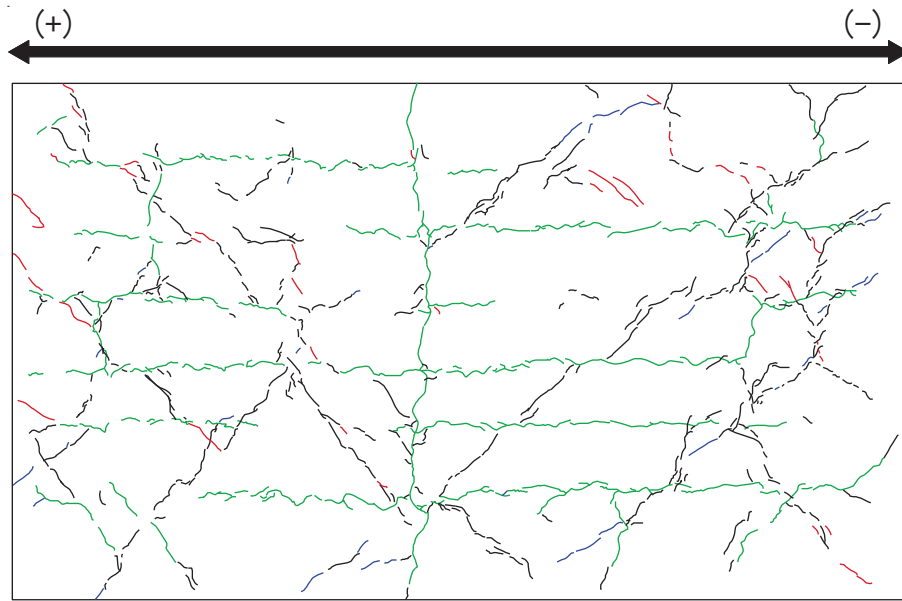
(7) 乾燥試験体 [1] 1/1250rad. におけるひび割れ図
